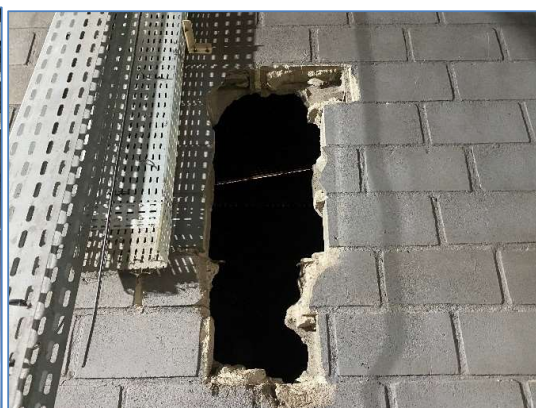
vista interna do galpão/barracão, mau estado de conservação, paredes danificadas.
